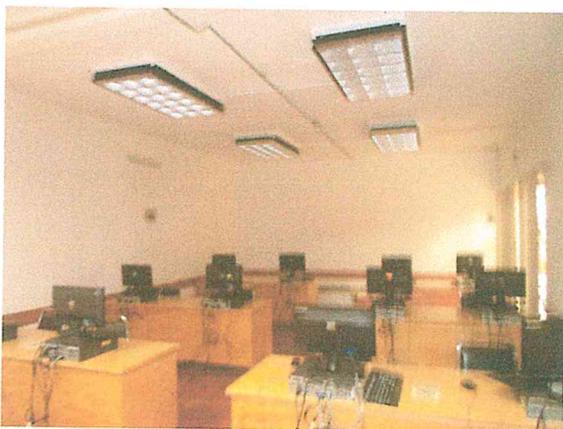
Muros, firmes y losas del aula de cómputo, en buen estado estructural.
